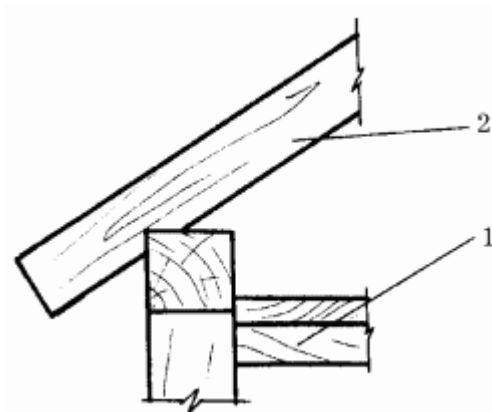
Опираие наслонных стропил в деревянных каркасных зданиях: 1 – балка перекрытия; 2 – стропильная нога.
